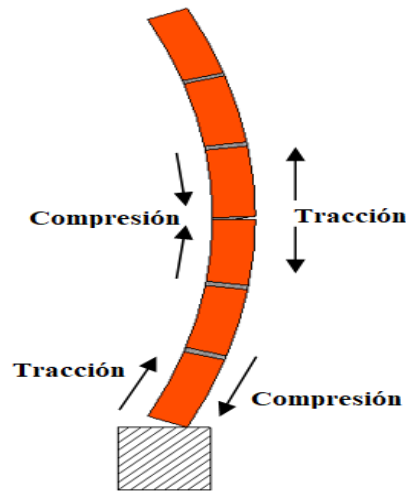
Esfuerzos por pandeo en muros de mampostería.
